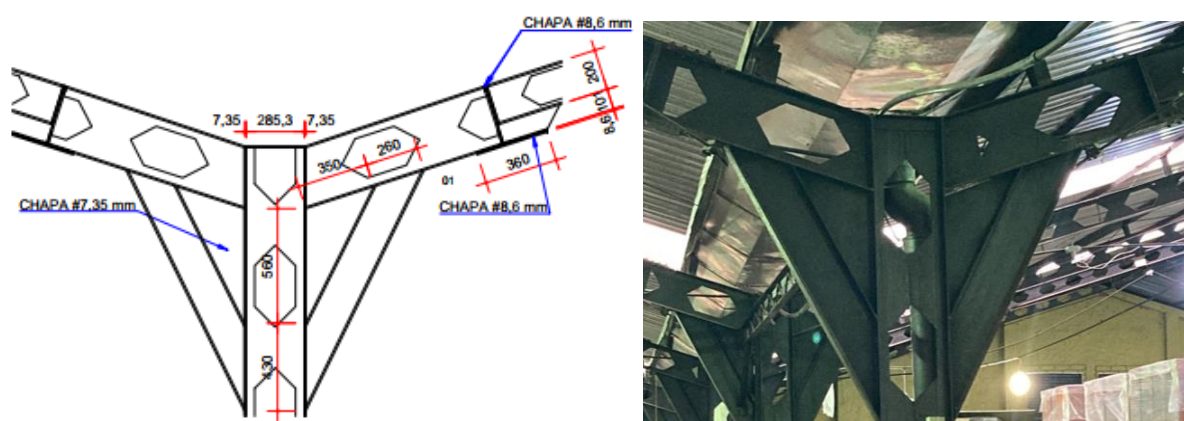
SEÇÃO TÍPICA DA VISTA DA TESOURA DO MEIO (DIMENSÕES EM MM)
